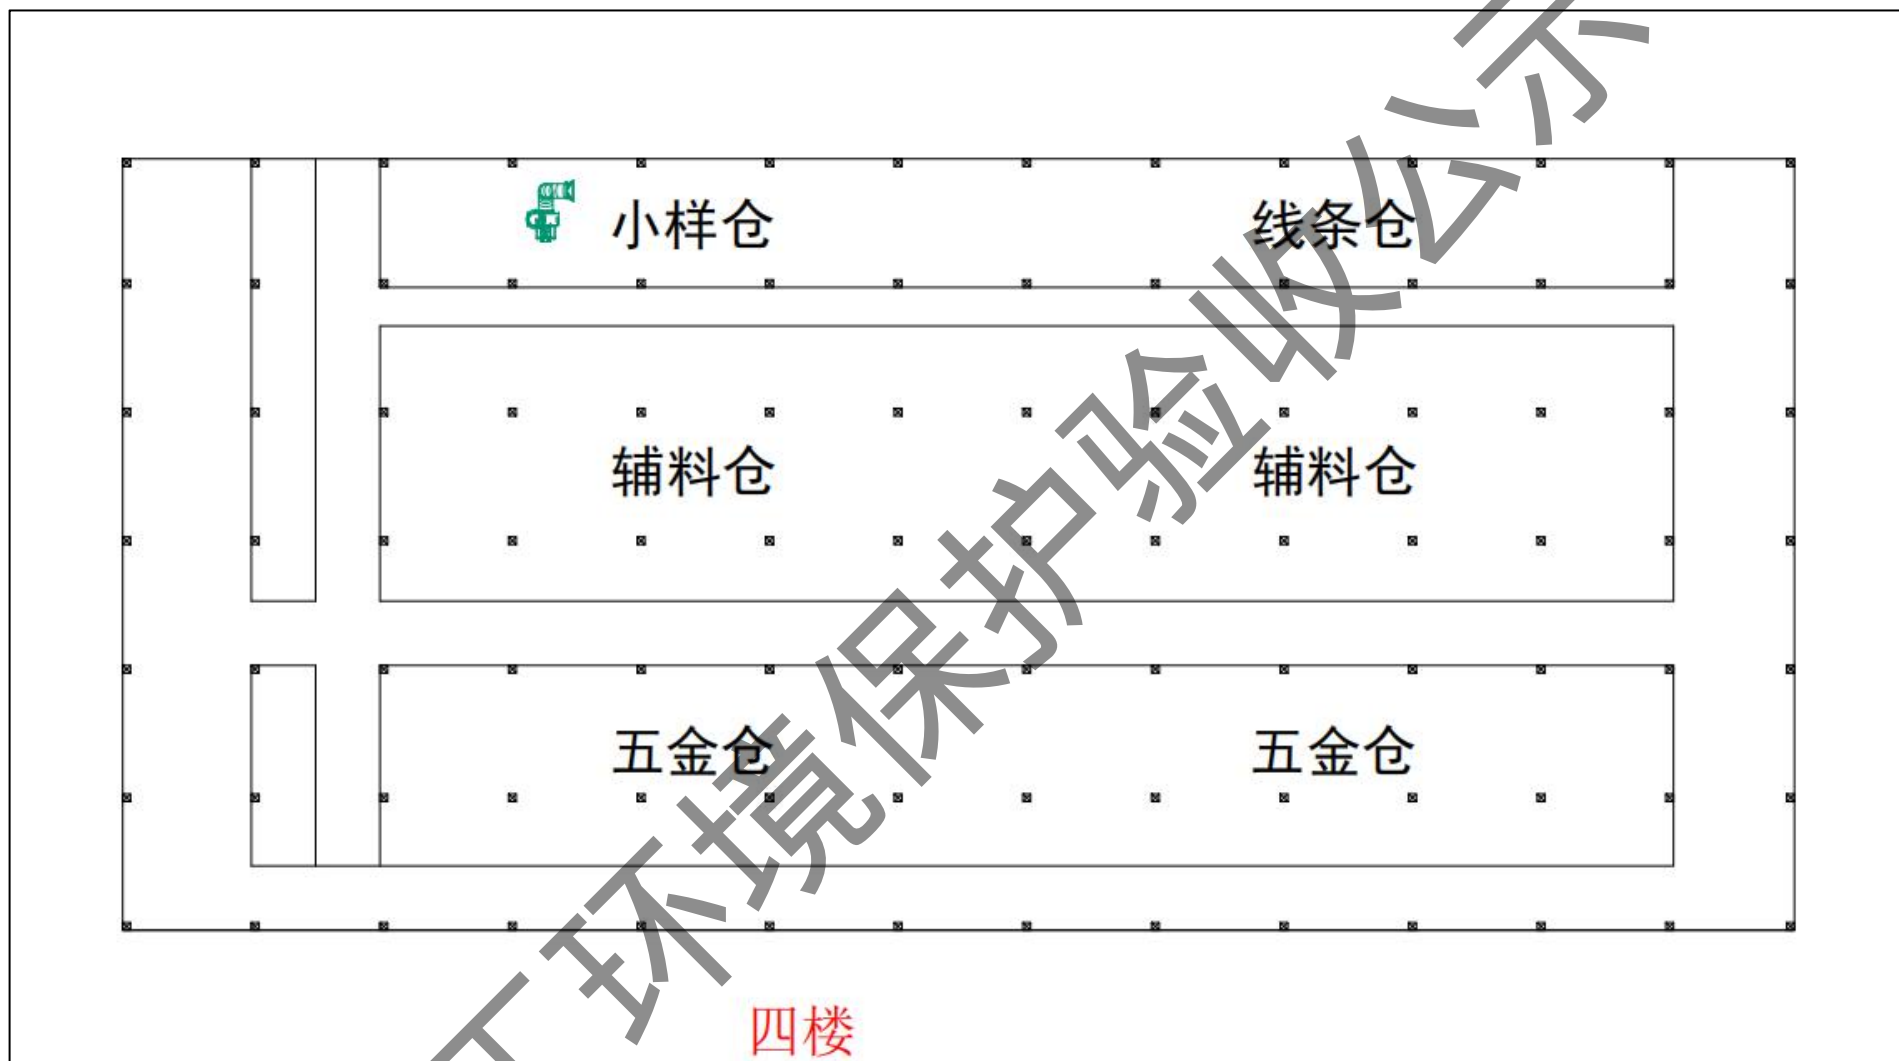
(5) 平面布置图 (生产厂房四层)
